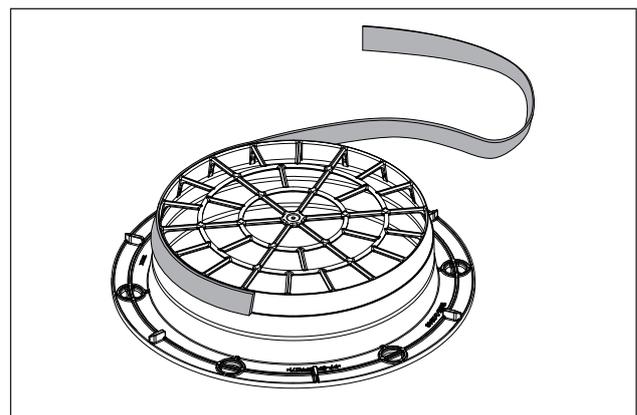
Position Dichtungsband für Montage mit Rundrohr
